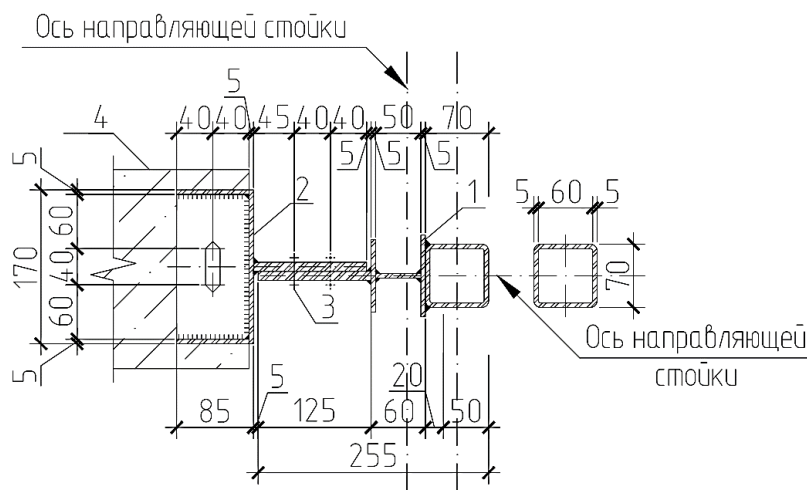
Схема крепления направляющей стойки составного сечения к кронштейну: 1 – направляющая стойка составного сечения, 2 – кронштейн, 3 – болт $d=16$ мм, 4 – железобетонное перекрытие
